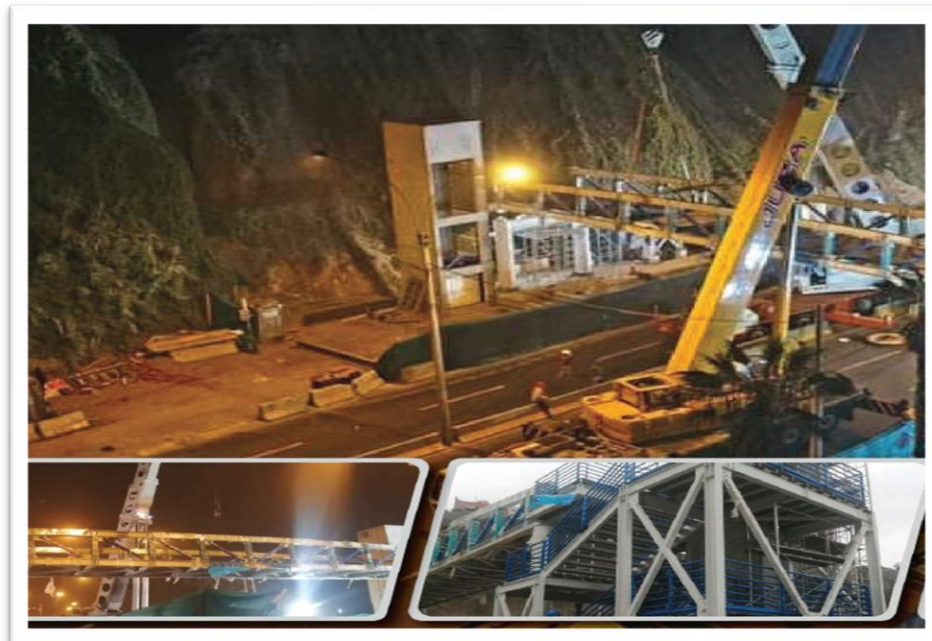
Puente Marjani, Ubicación Tacna Perú. Construcción JCB Estructuras 2020
